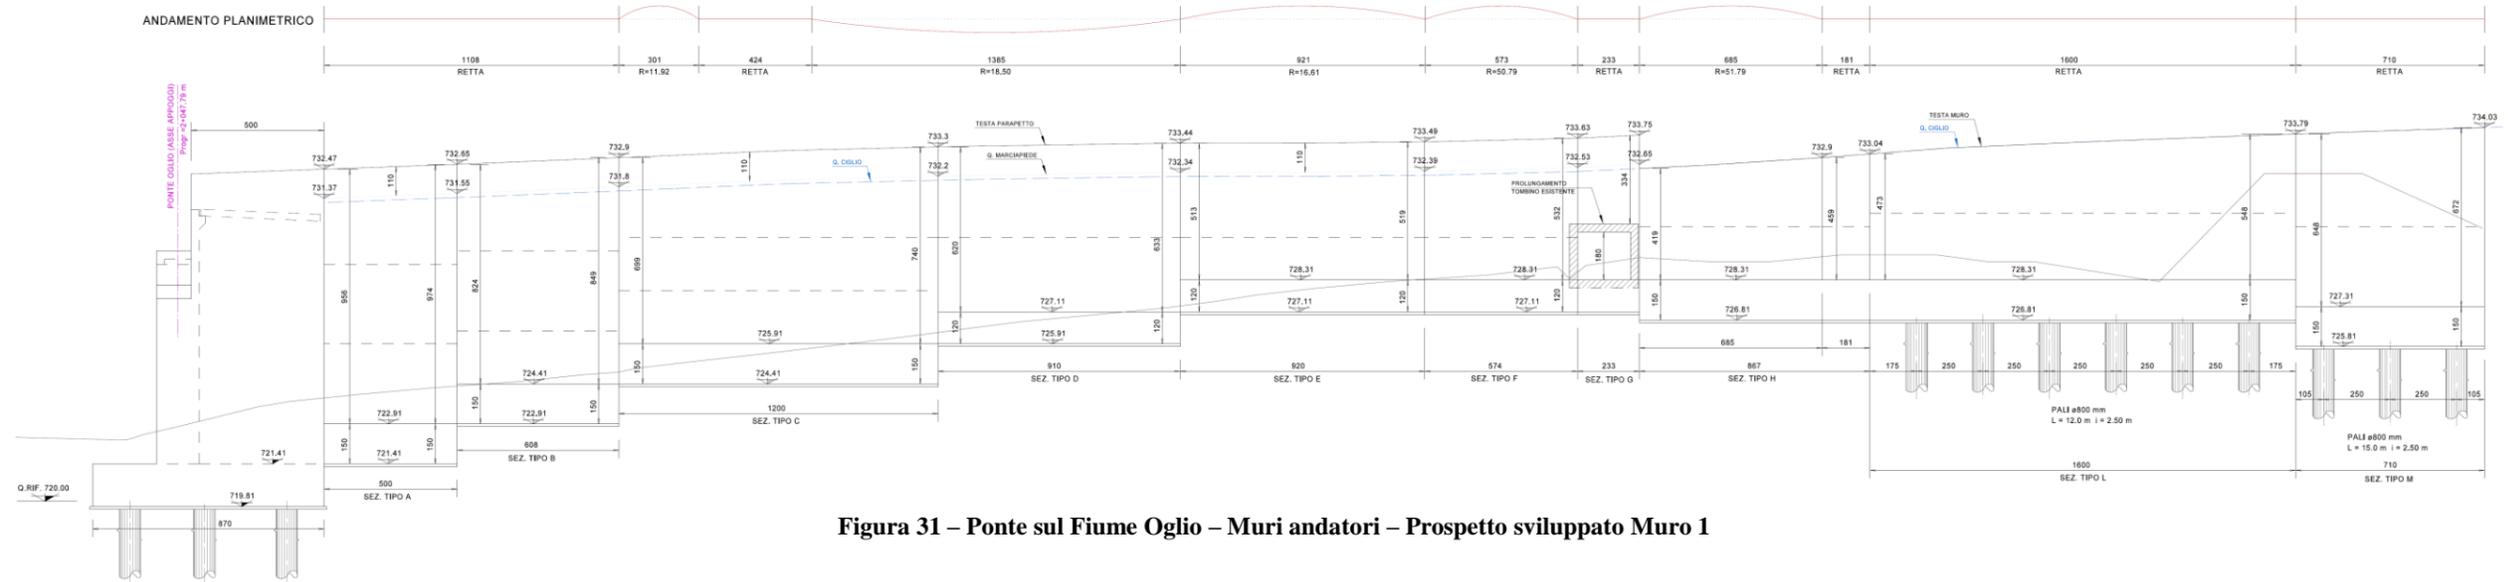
Ponte sul Fiume Oglio – Muri andatori – Prospetto sviluppato Muro 1
